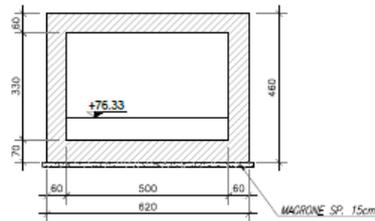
SL27 - Sezione trasversale struttura scatolare
